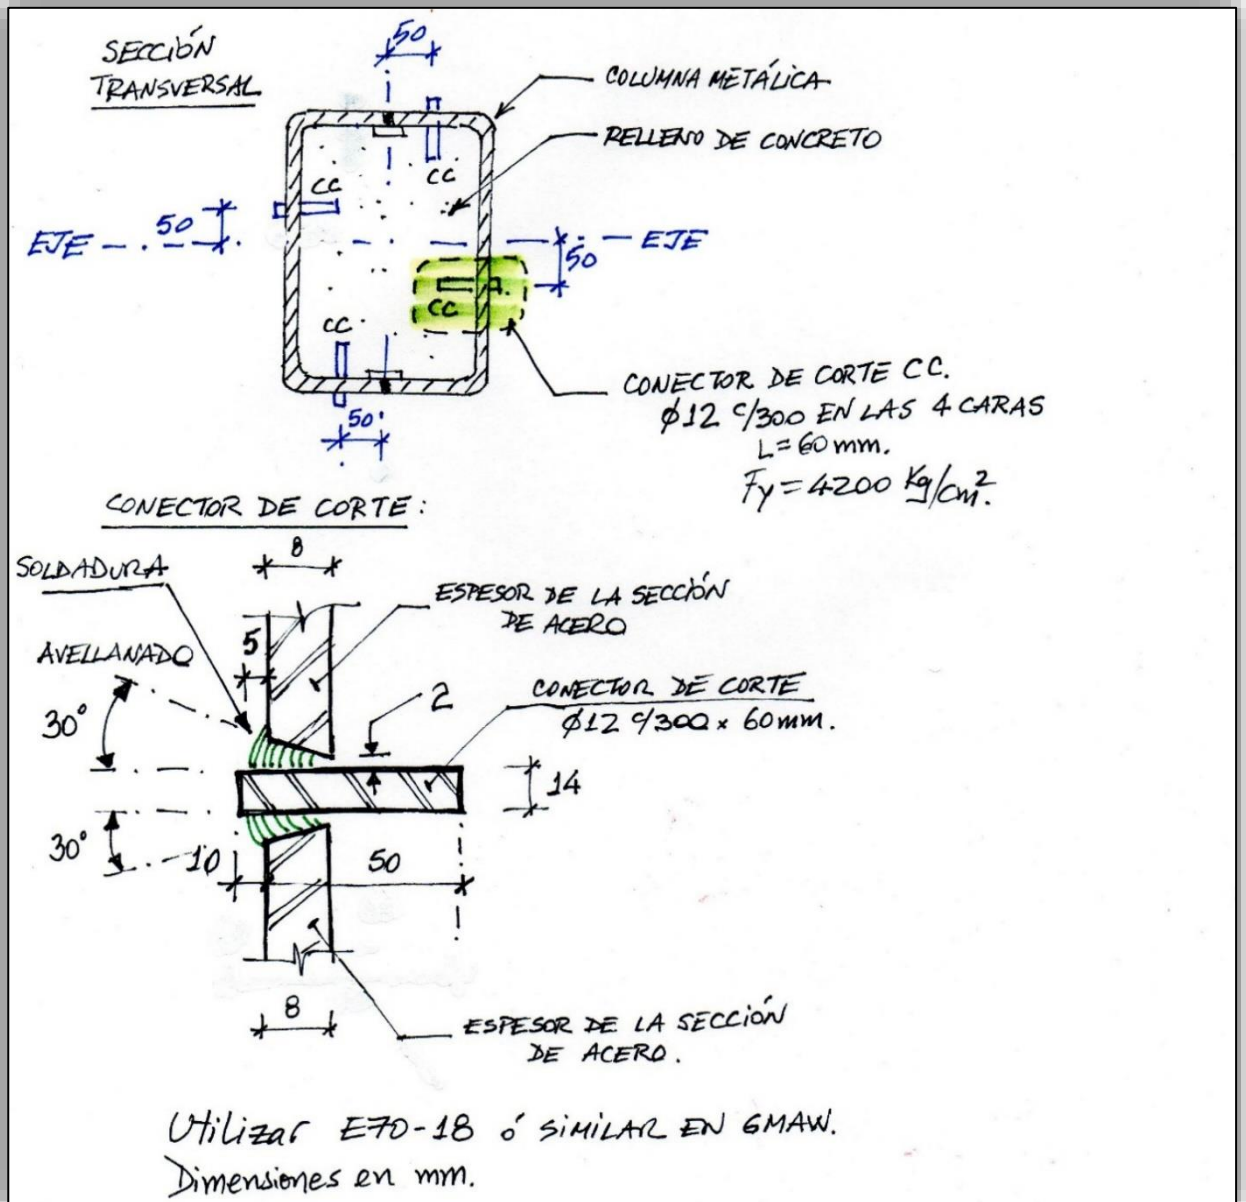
Solución a la ausencia de conectores de corte en columnas
